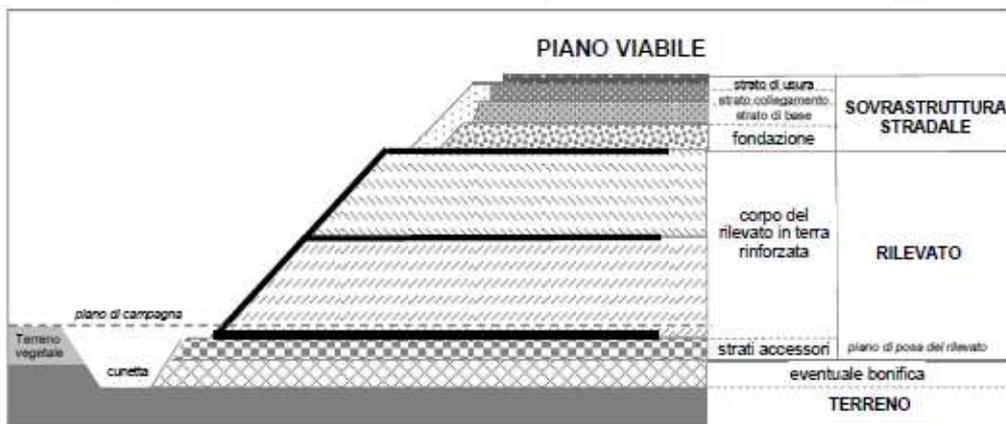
Esempio schematico di sezione del corpo stradale con rilevato in terra rinforzata
